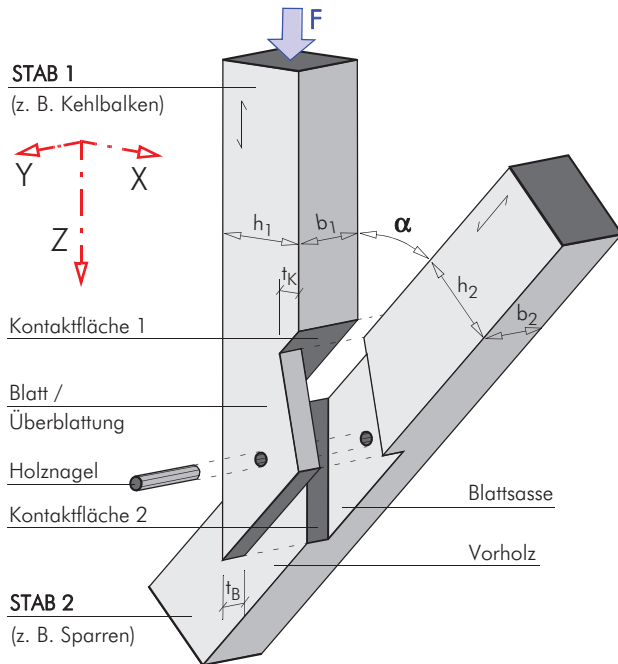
D.5 Explosionszeichnung der geprüften Weißschwänze (Überblattungen siehe Text): Querschnitts- und Verbindungsabmessungen sowie Bezeichnungen.
